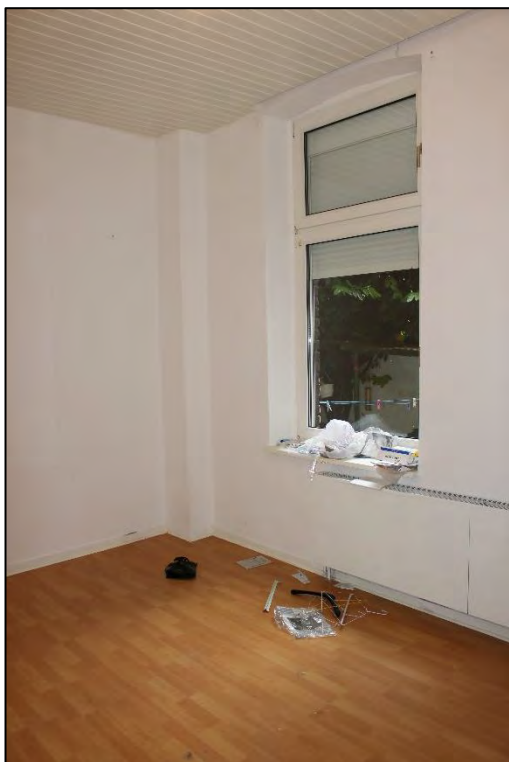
Erdgeschoss, WE Nr. 1, Schlafzimmer
